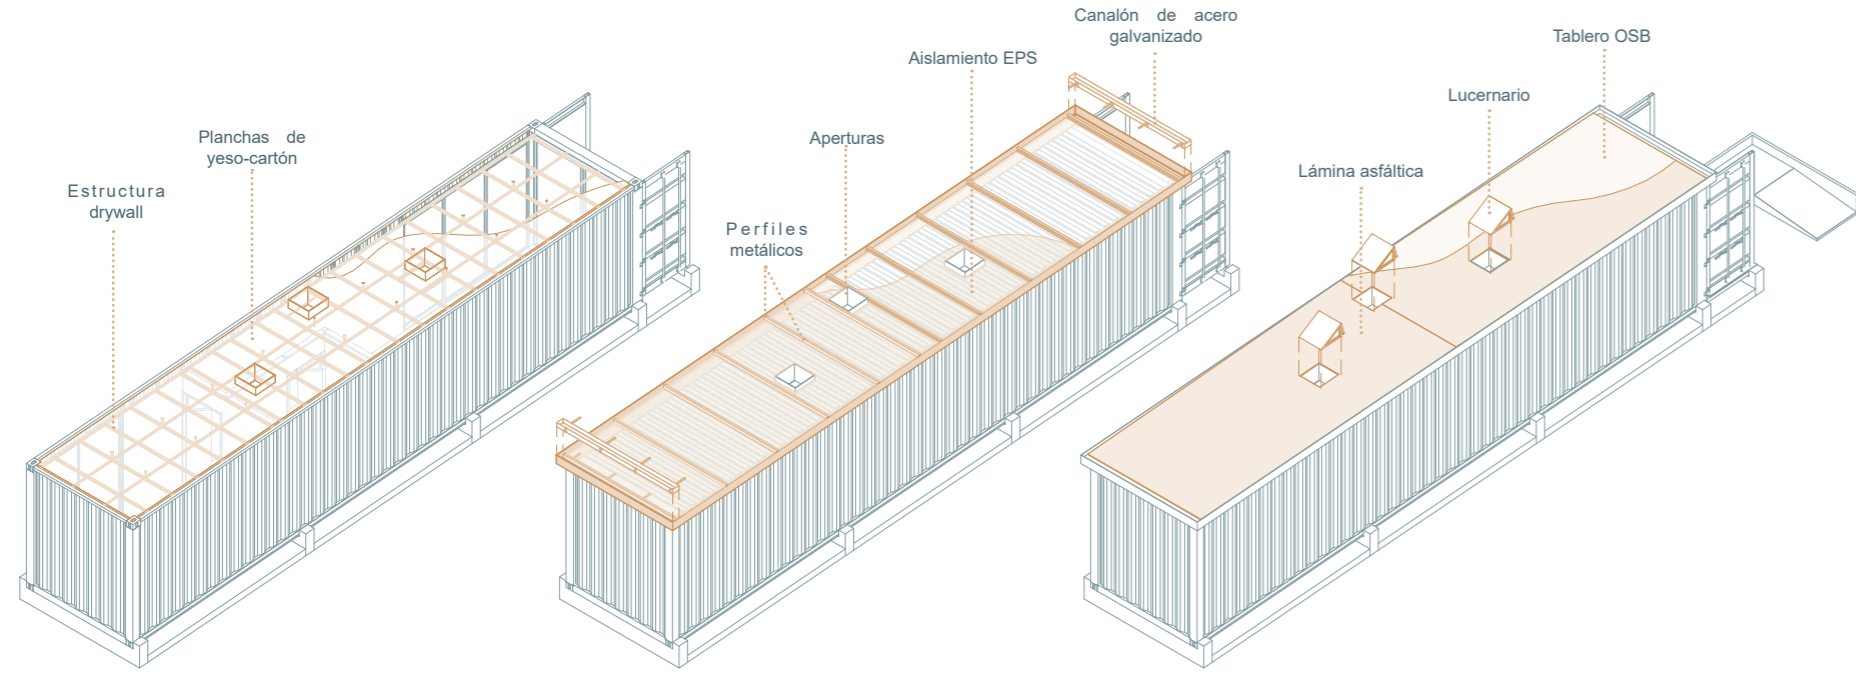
Proceso constructivo vivienda tipo 1. Fuente: Autores, 2023
